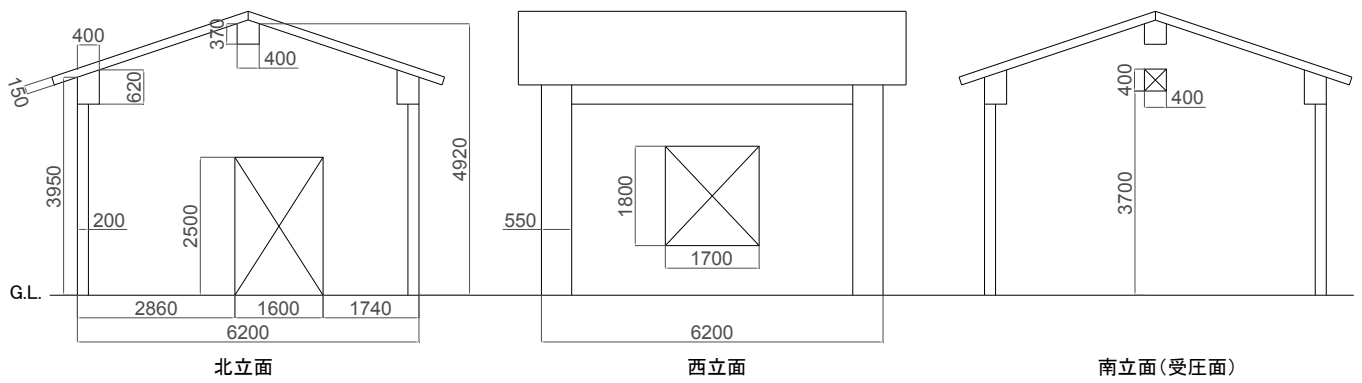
調査対象建物 立面図 (単位 : mm)
